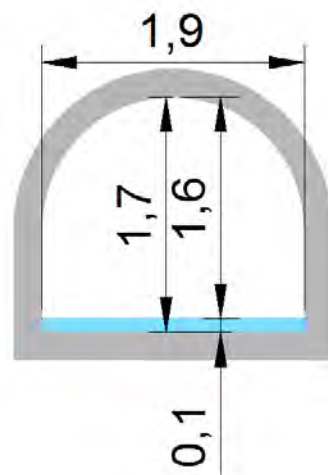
Profil en travers de l'ouvrage hydraulique de l'affluent du ruisseau de la poterie (source : SEGIC)
